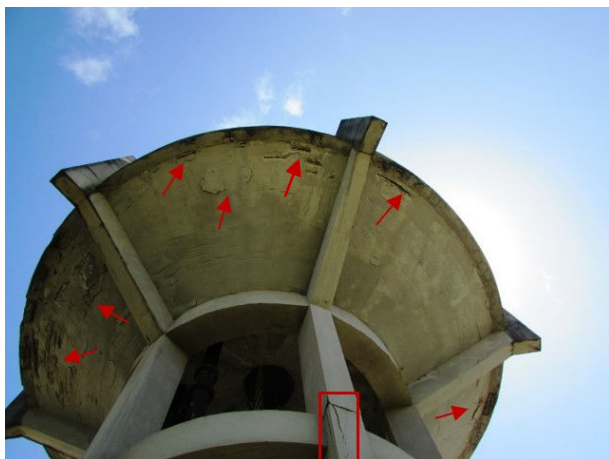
Vista geral do fundo da cuba, em destaque rachadura no pilar no 2º lance (retângulo), corrosão da armadura e deslocamento do concreto (setas)
